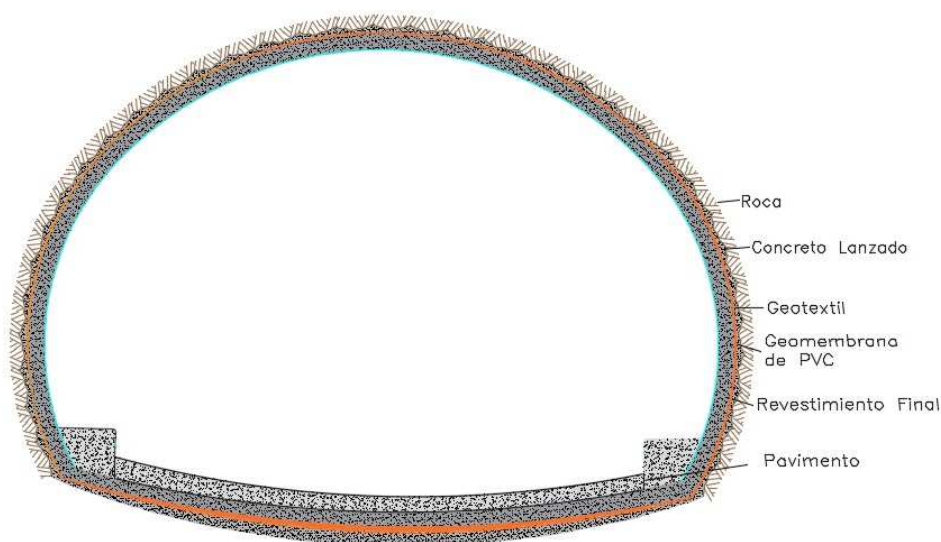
Membrana de PVC en un túnel excavado con agua de infiltración a presión
